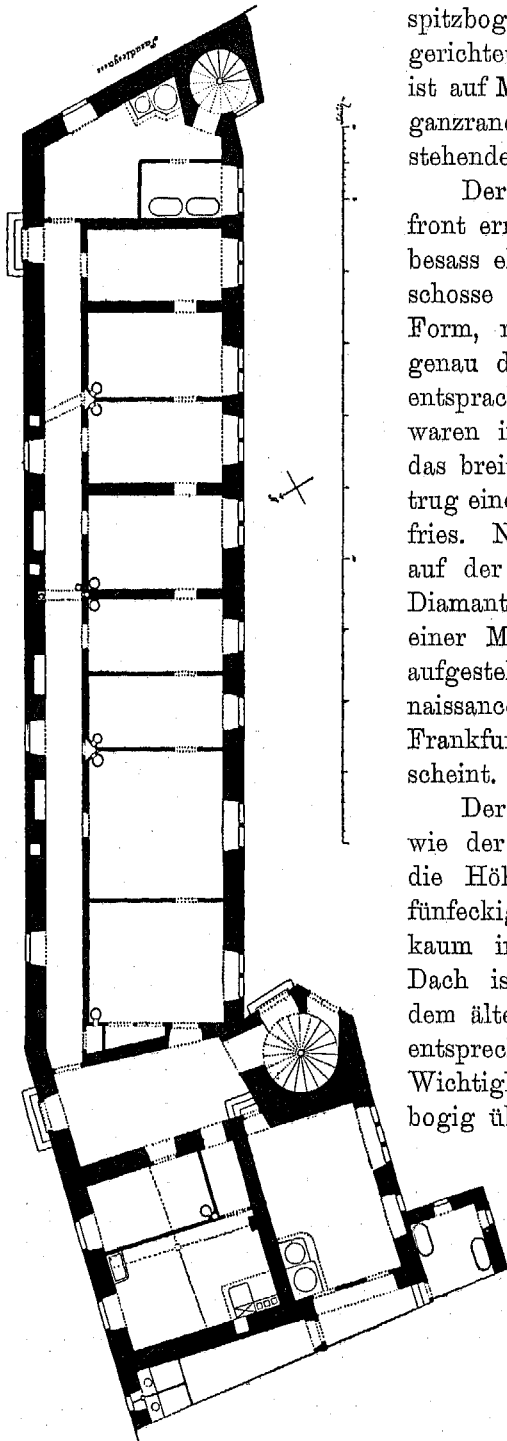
Frankensteiner Hof; Grundriss des Erdgeschosses.
